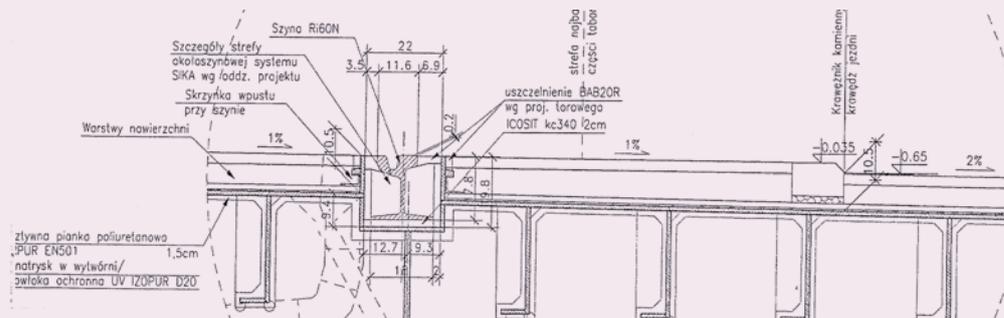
détail d'une zone particulière au droit des rails – Source : Colas
